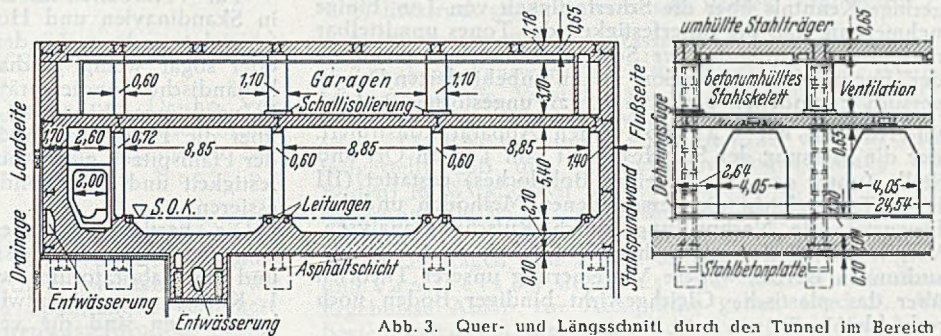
Quer- und Längsschnitt durch den Tunnel im Bereich des 1. Bauabschnitts.
